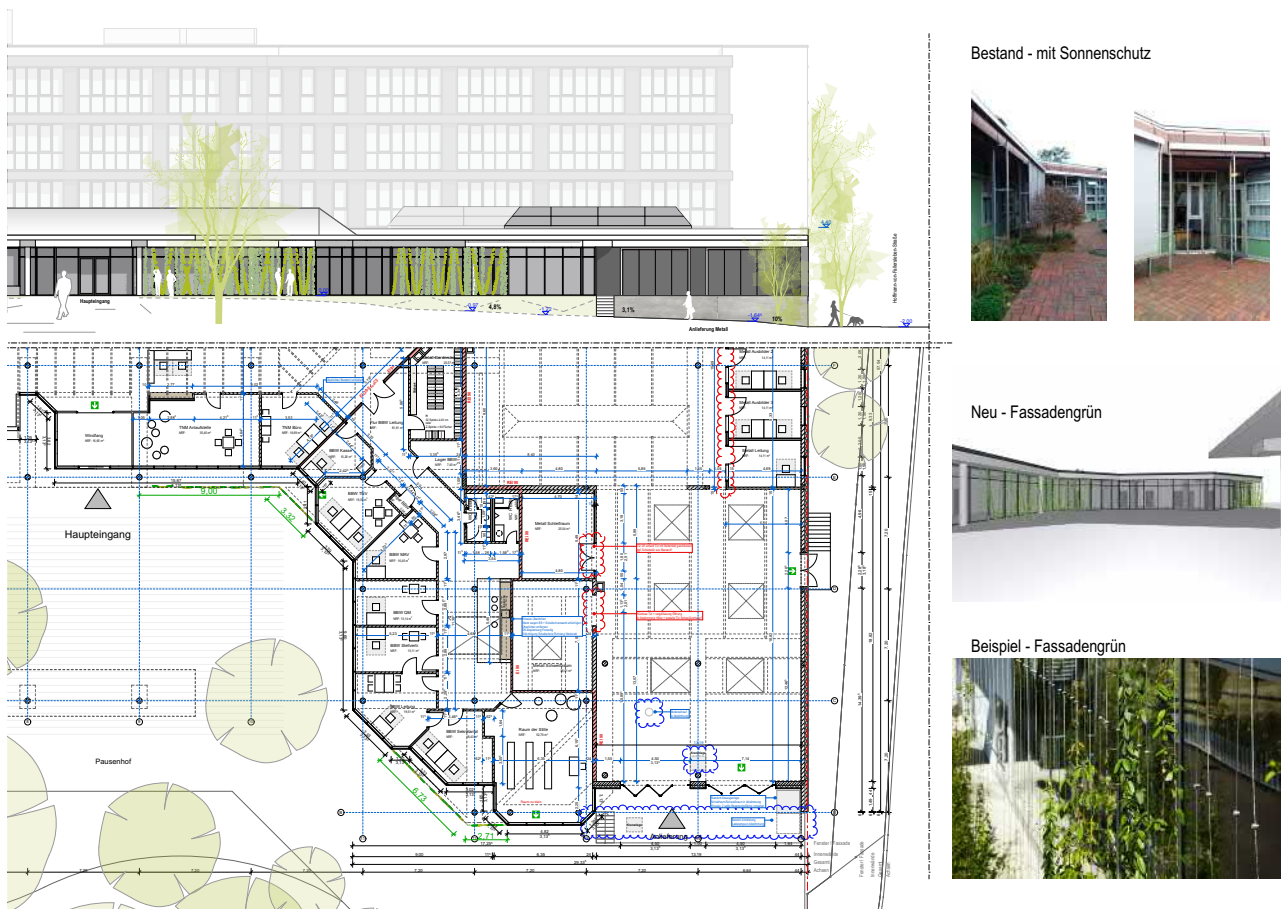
geplante Fassadenbegrünung nördlicher Haupteingang, Quelle: foundation 5+ Architekten & Baufrosche
